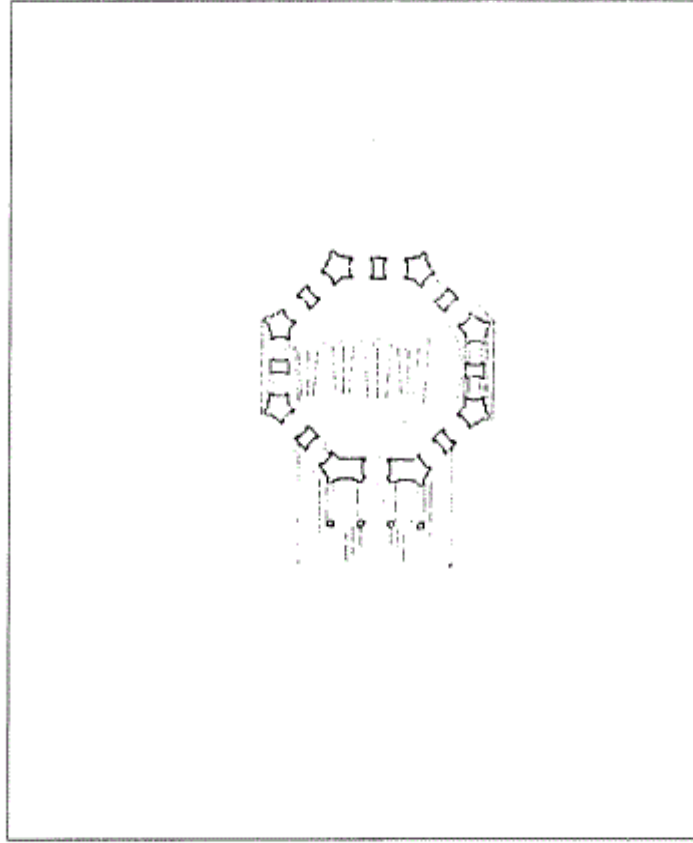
مسقط أفقي لمجمع (كلية) كوتچك أفندي في إسطنبول (عن : جودوين) .
